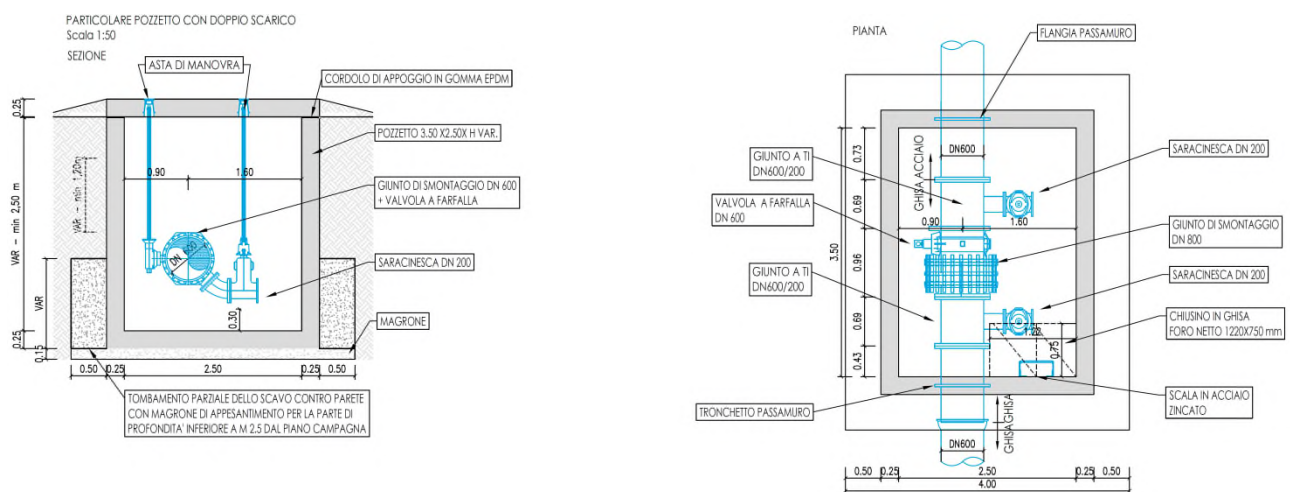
Pozzetto con doppio scarico – Sezione e Pianta
